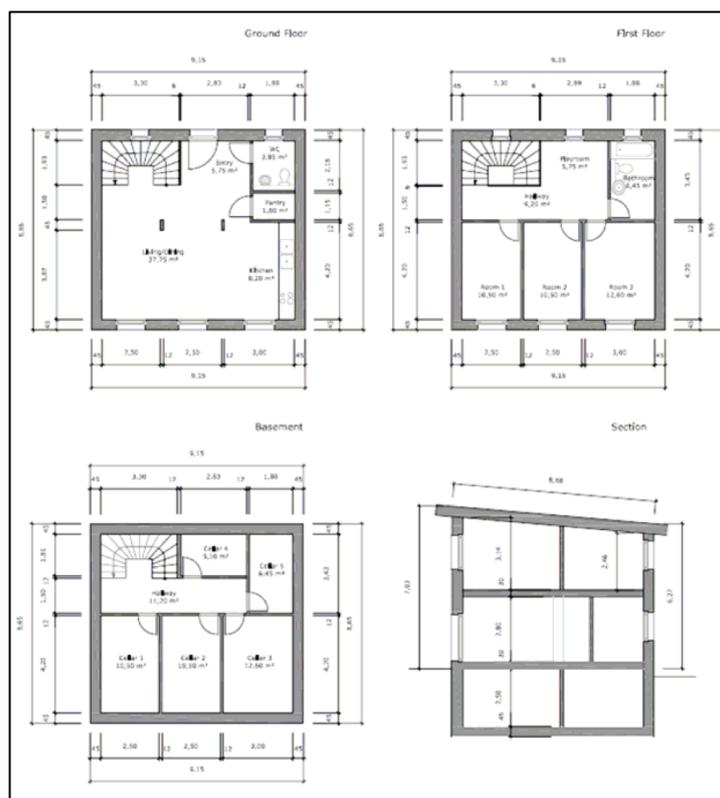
Grundrisse und Schnitt - IBO-Modell-Einfamilienhaus<sup>185</sup>
